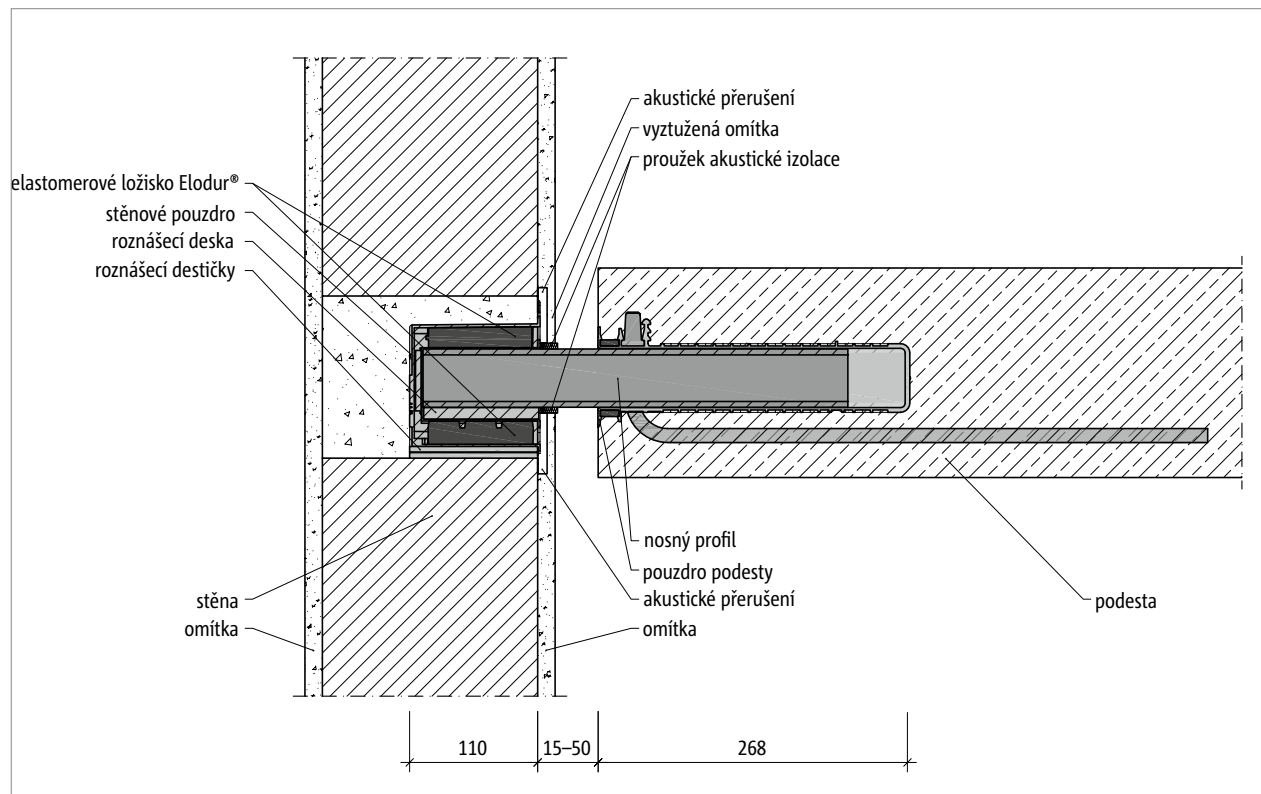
Schöck Tronsole® typ P: Řez napojením s prefabrikovanou podestou a vzduchovou mezerou
